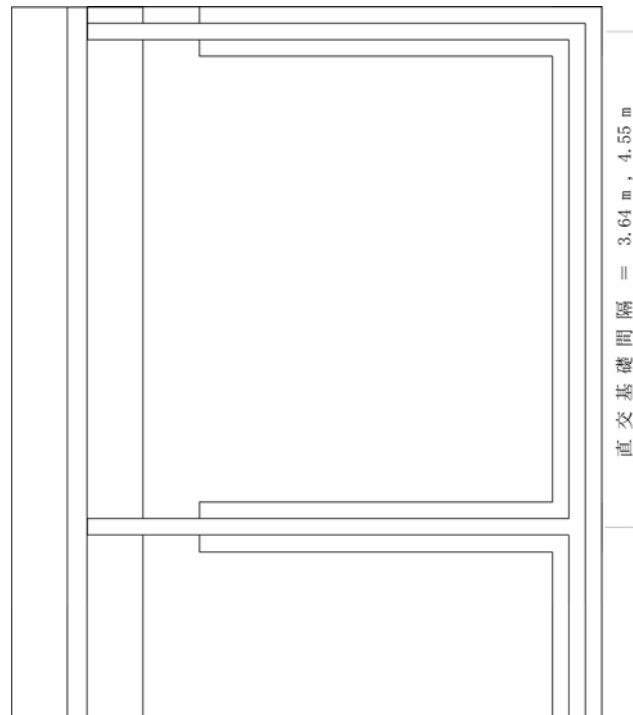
2 布基礎 - 直接基礎による立ち下げ (平面図)
